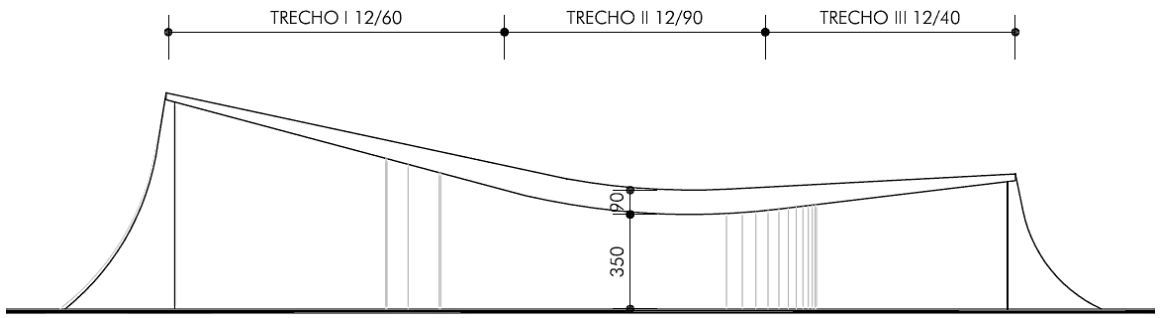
| ICSQ. Viga da fachada VF1. Variação das seções
